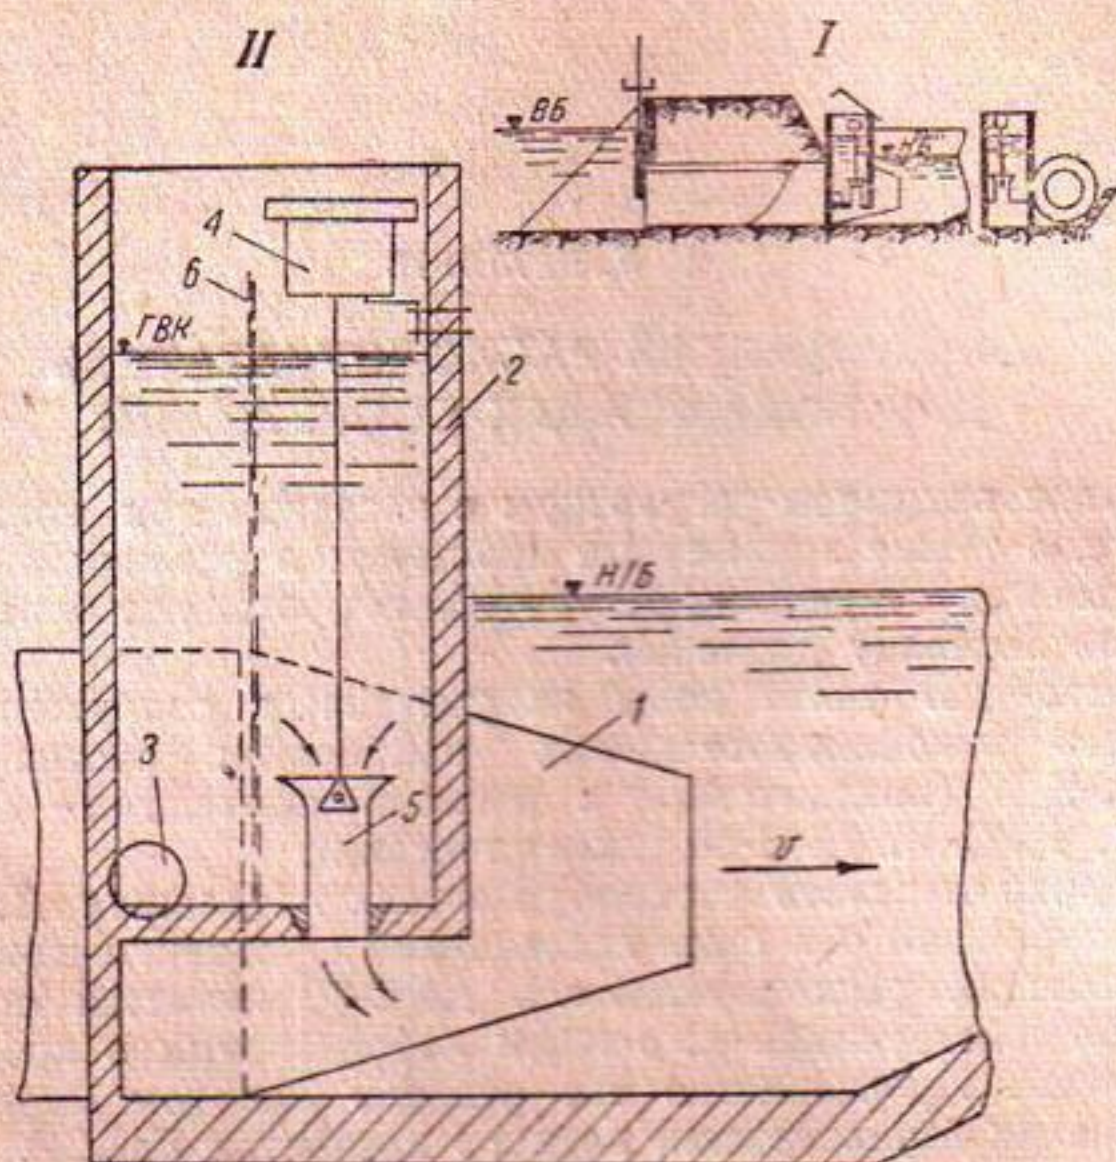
Схема монтажа ДРС-60 на трубчатом водомере-регуляторе с насадком:
